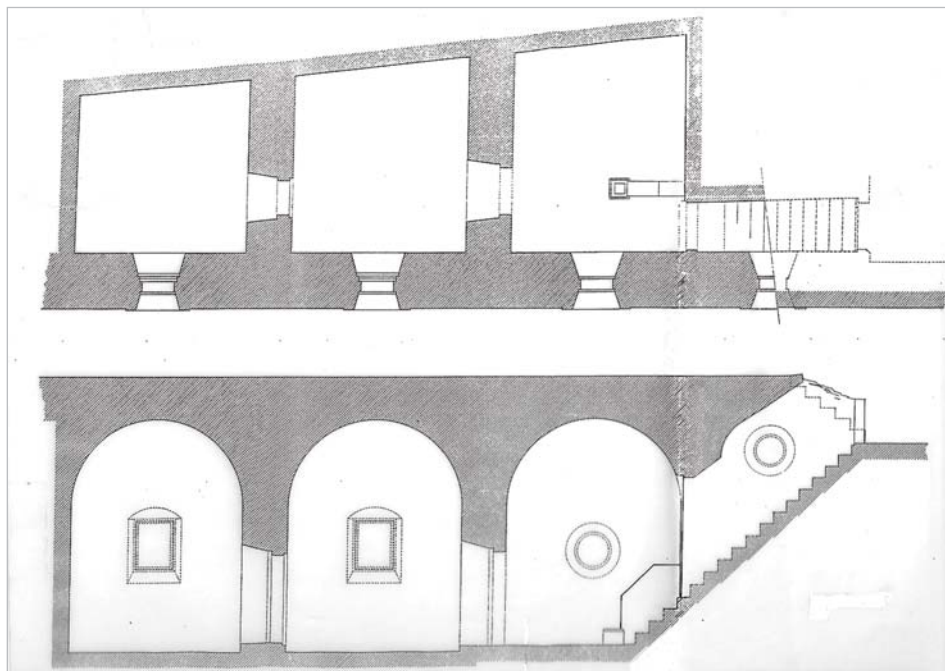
Planta y alzado de las denominadas oficinas (F. Cebrián)
